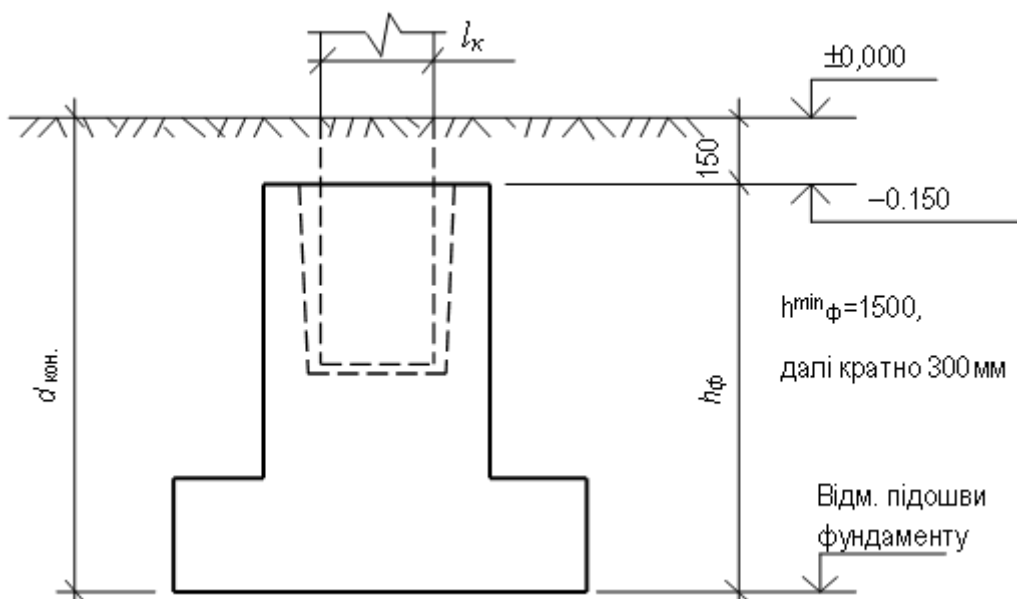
Попереднє конструювання окремого (стовпчастого), монолітного фундаменту під збірну залізобетонну колону (без підвалу)
